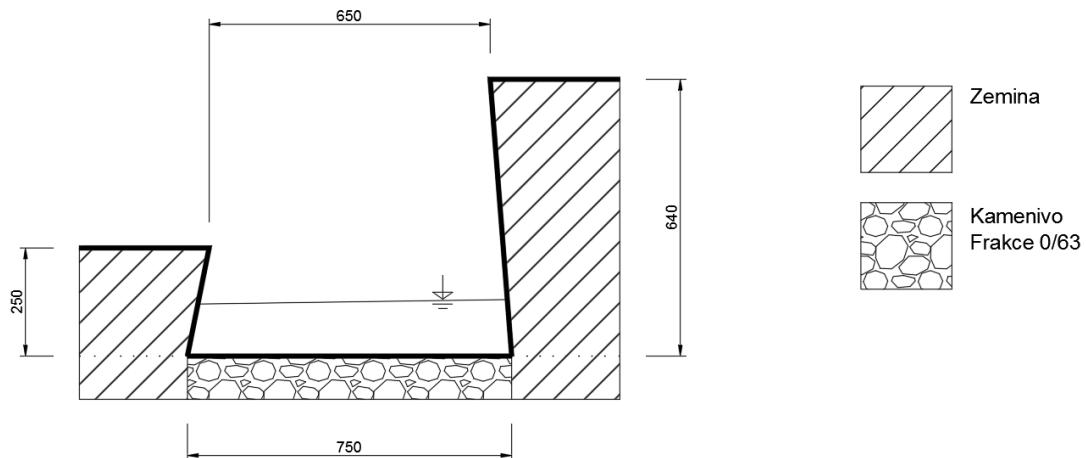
Schéma příčného profilu č. 5 - za soutokem
